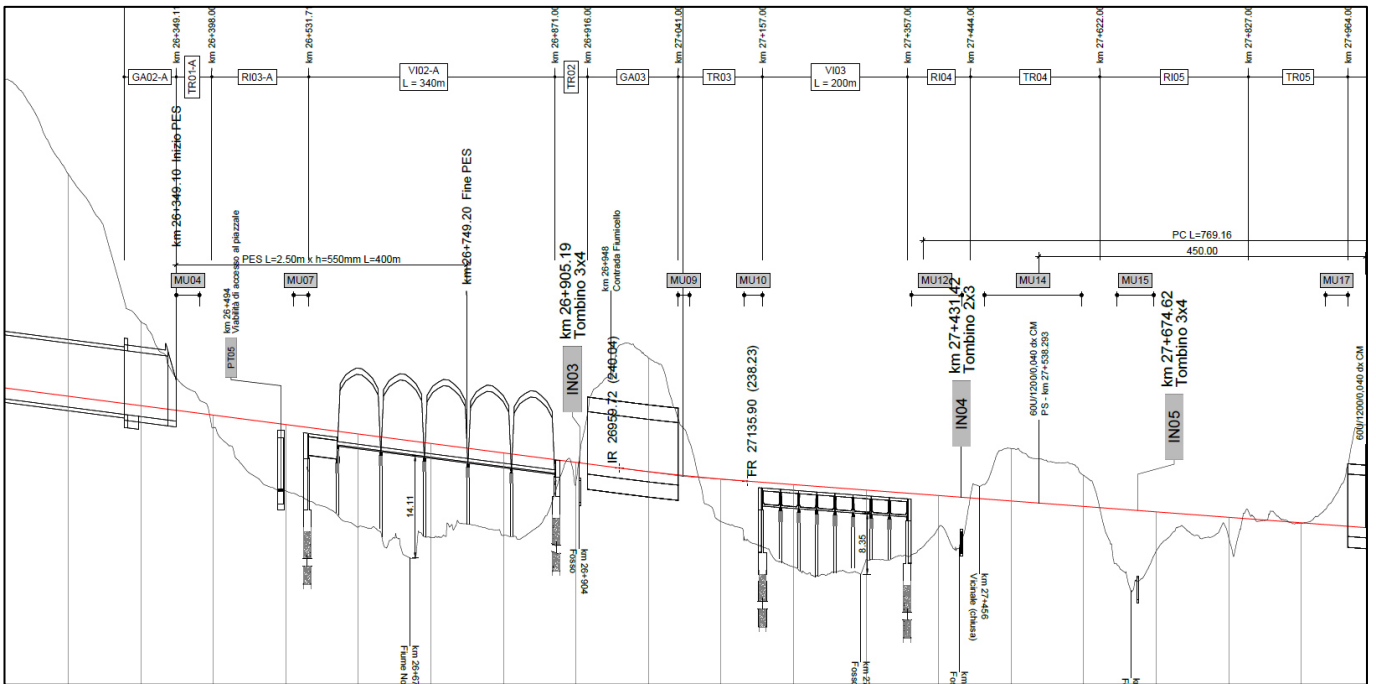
Profilo di progetto da km 26+349 al km 27+964 BP
